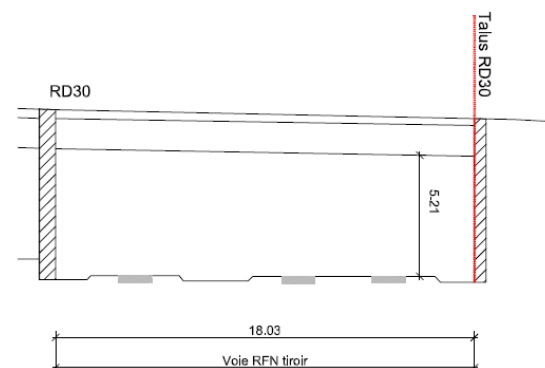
Coupe de l'existant sous l'ouvrage de la RD30
